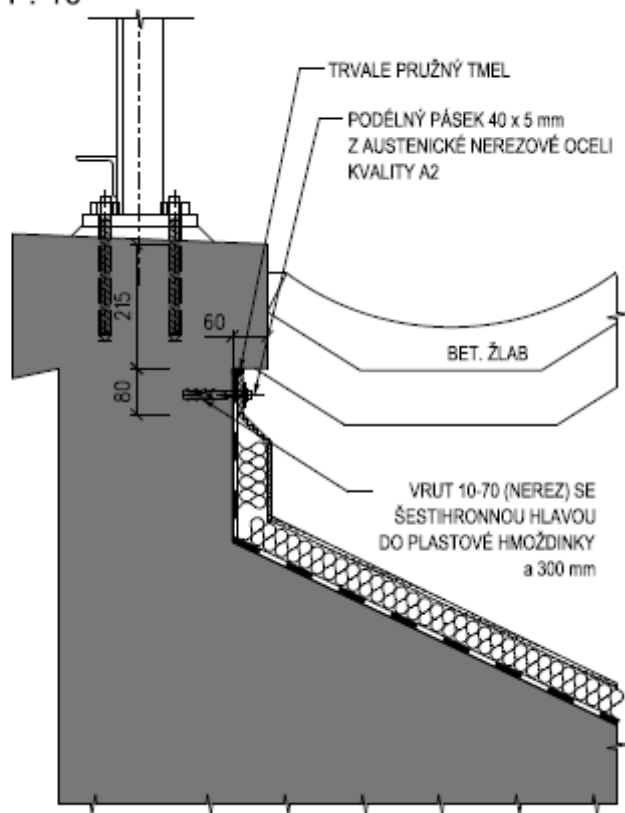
ODVODNĚNÍ ZA RUBEM, 1.ČÁST
